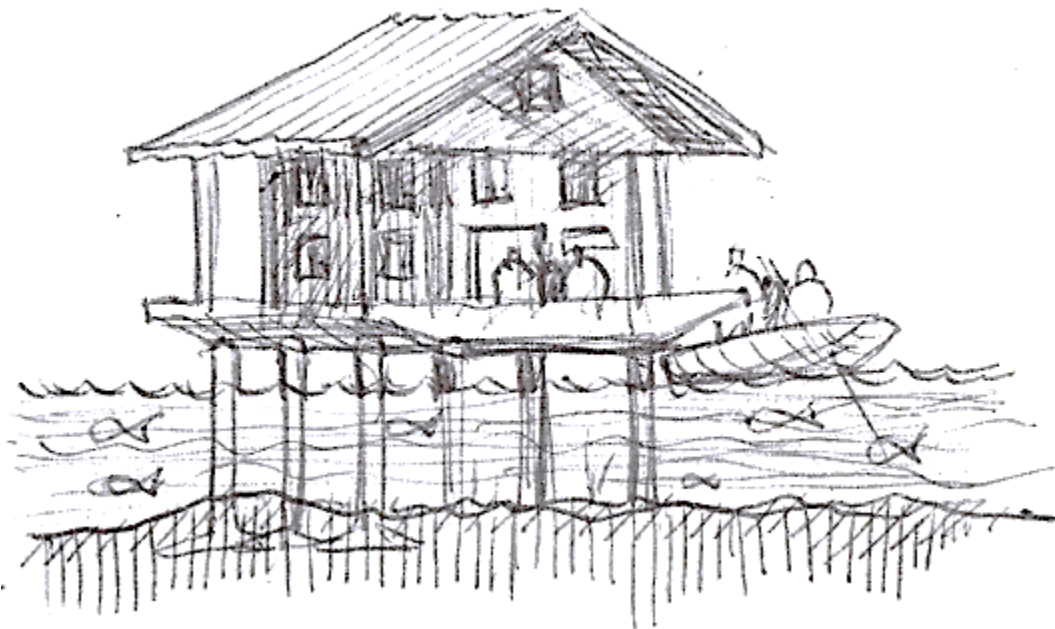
Casa con piso elevado sobre un amazón soportante de morillos o alternativas de concreto armado
